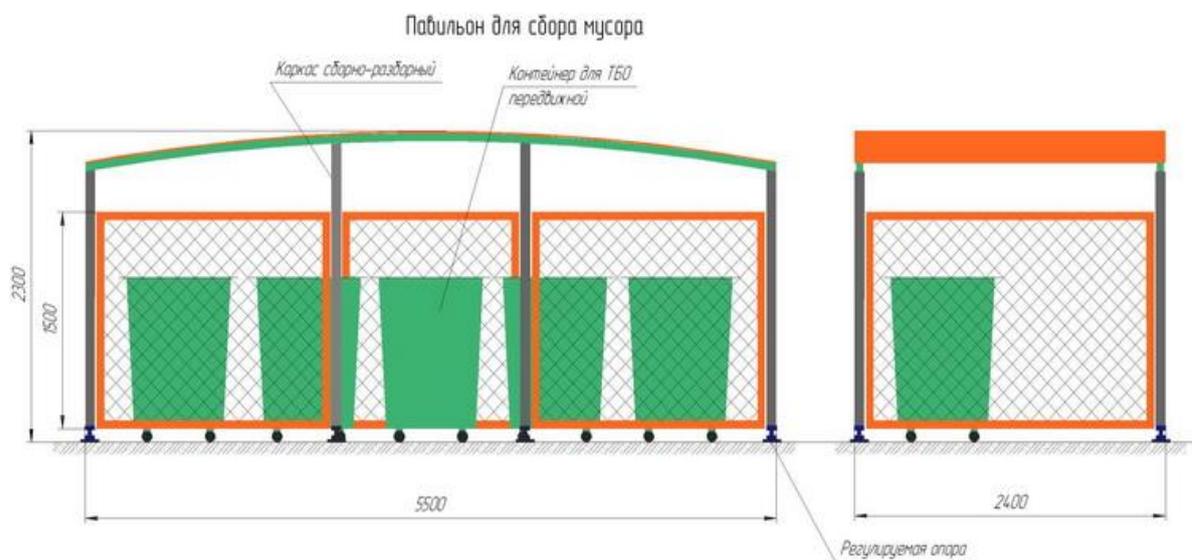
Схема контейнерной площадки КПЛ-2
